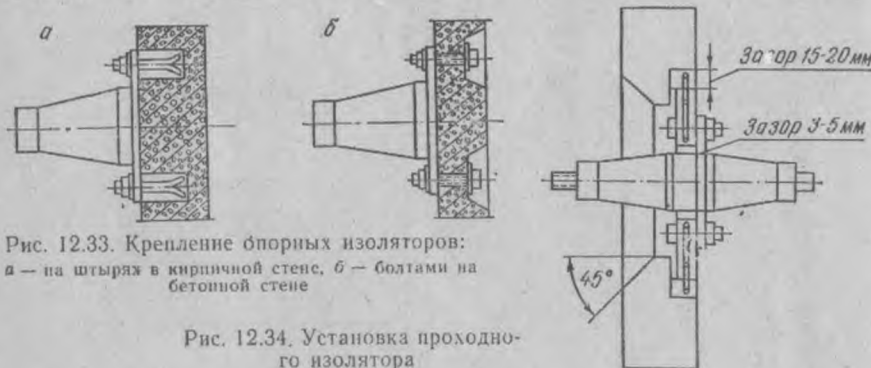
Крепление опорных изоляторов: *a* — на штырях в кирпичной стене, *b* — болтами на бетонной стене
